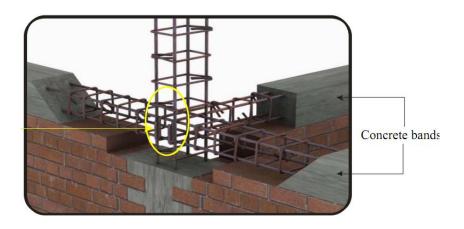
Расположение железобетонной колонны в теле кладки (рекомендации Пакистана)
